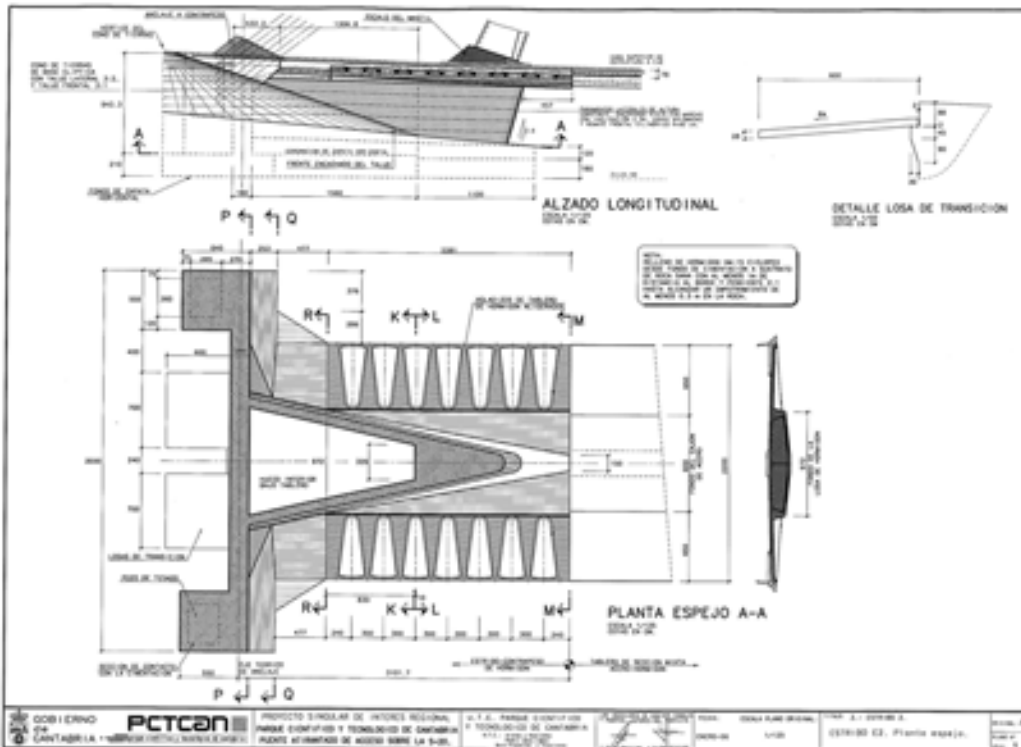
Plano de definición general del Estribo contrapeso con su configuración en cuña
